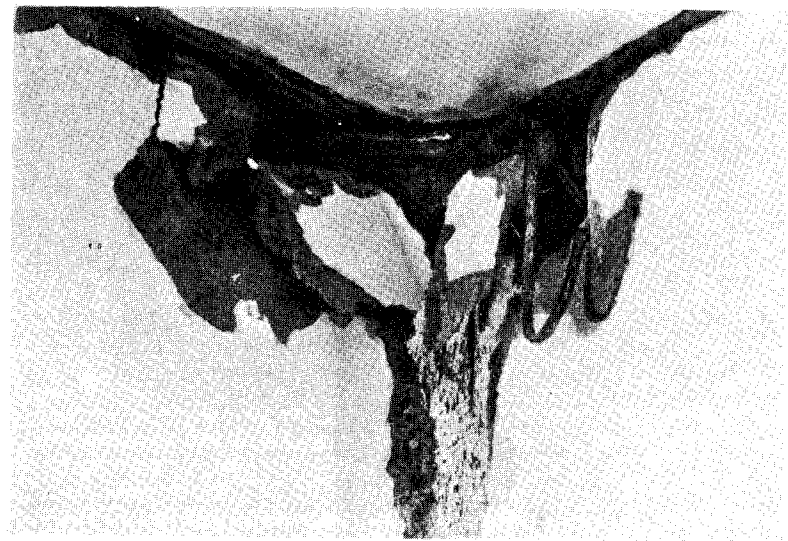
Вырывы закладной детали и смещение стен относительно перекрытия
